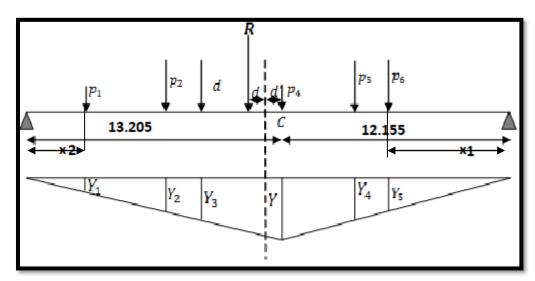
Disposition de deux camions sur la chaussée (sens longitudinale)
